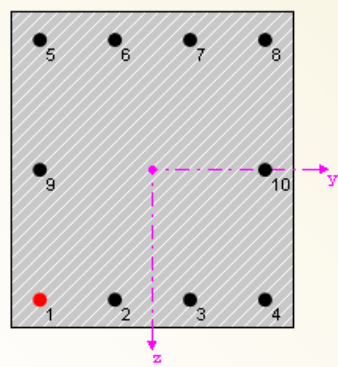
Gewählte Längsbewehrung mit konstruktiver Bewehrung
